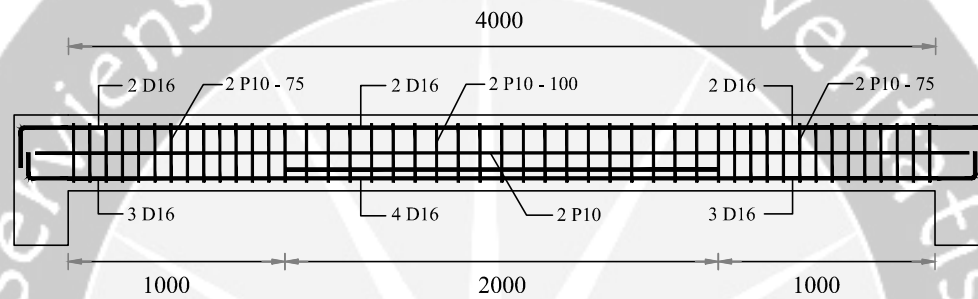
DETAIL PENULANGAN BALOK INDUK B1 400 x 600
